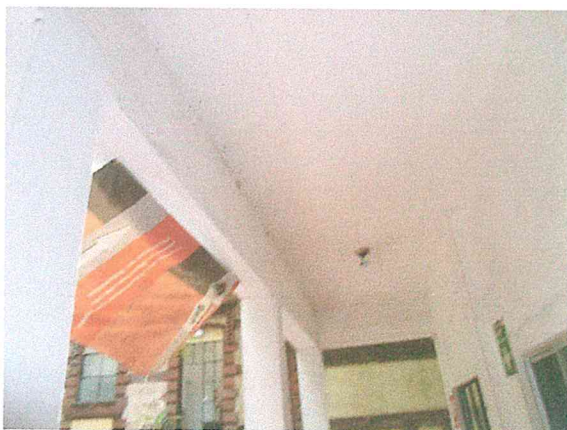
Columnas, traves y losa del Edificio B, sin afectaciones estructurales.
